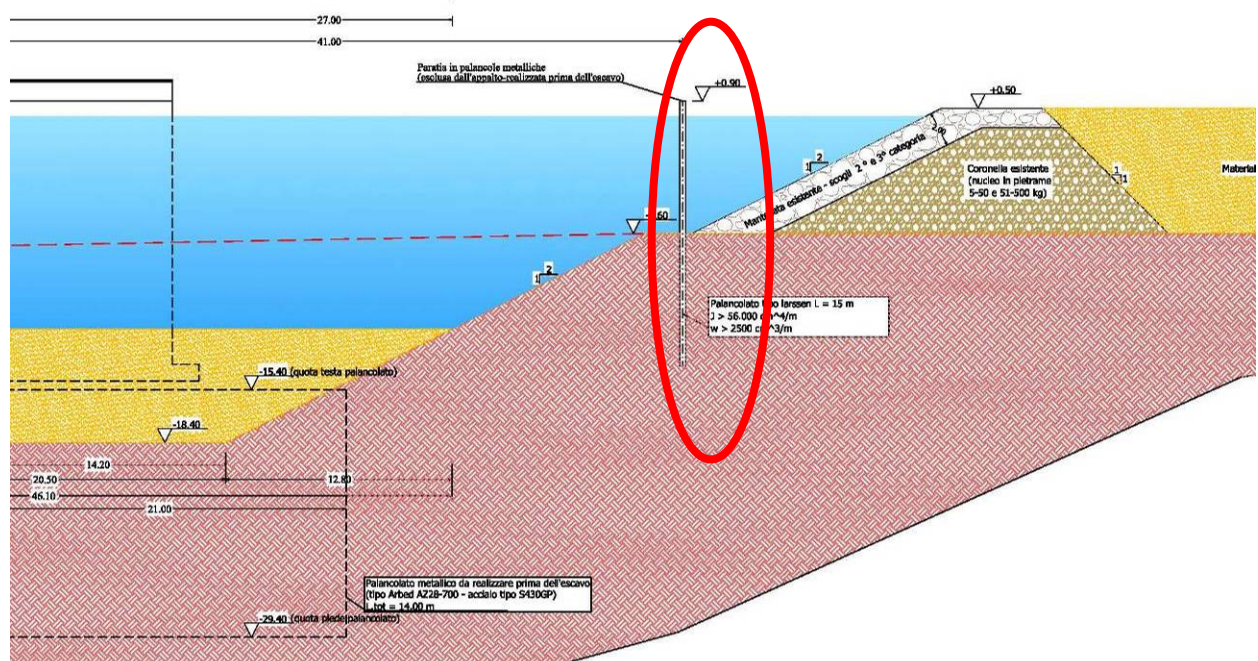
Dettaglio della sezione di escavo prevista in progetto esecutivo banchina 27
